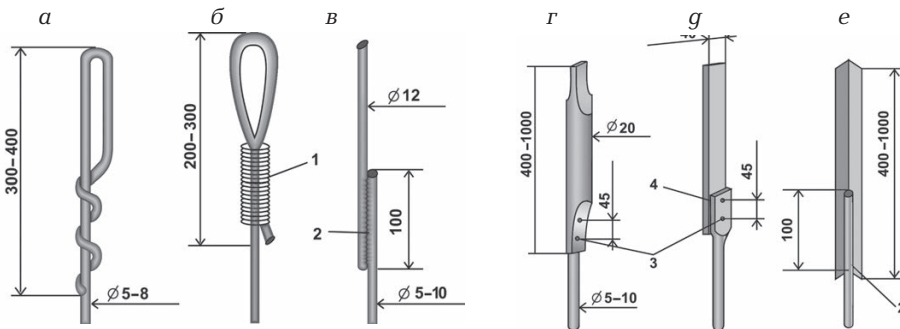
Варианты изготовления молниеприемника (мм): а, б — из стальной проволоки; в — круглой стали; г — водогазопроводных труб; д — полосовой стали; е — угловой стали; 1 — бандаж из оцинкованной проволоки диаметром 1,5–2,5; 2 — сварка; 3 — болт; 4 — свинцовая прокладка
